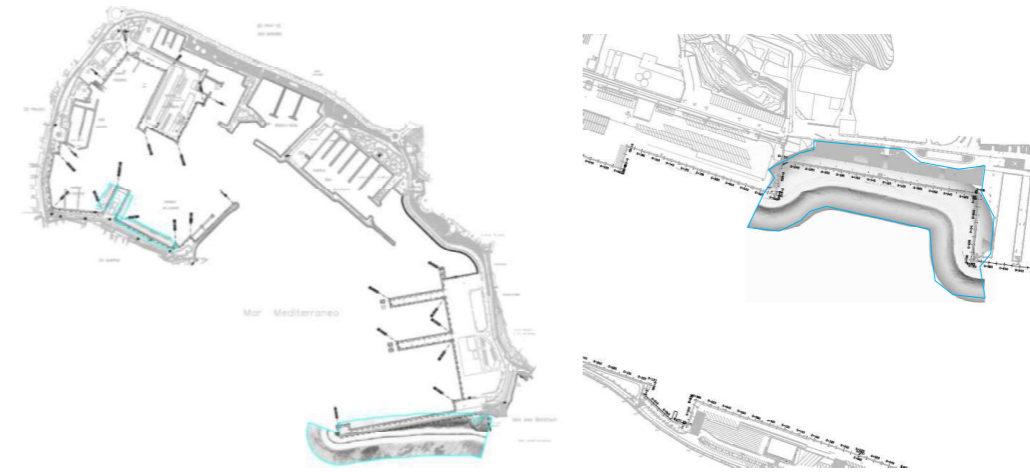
Zonas (enmarcadas en Azul) en planta de Puerto de Eivissa y Maó sujetas a inspección de Sónar de Barrido Lateral
